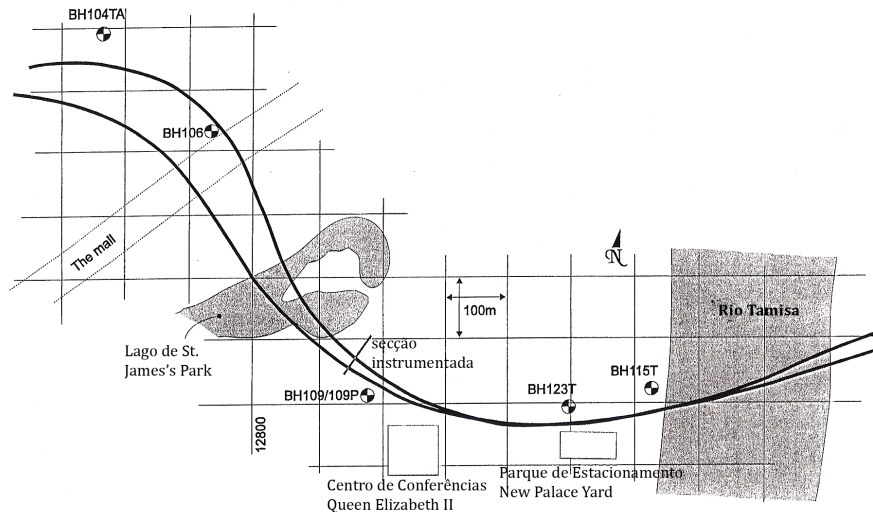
Planta da área de Westminster e St. James's Park (adaptado de Nyren, 1998).
